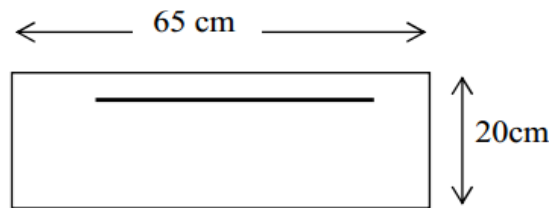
Coupe schématique de la poutrelle (travées).
